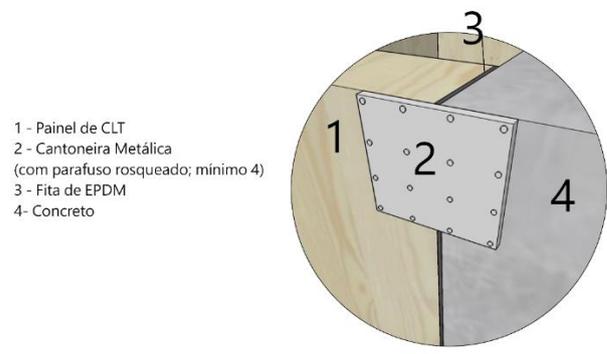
Detalhamento 01 – ligação CLT e concreto interno
